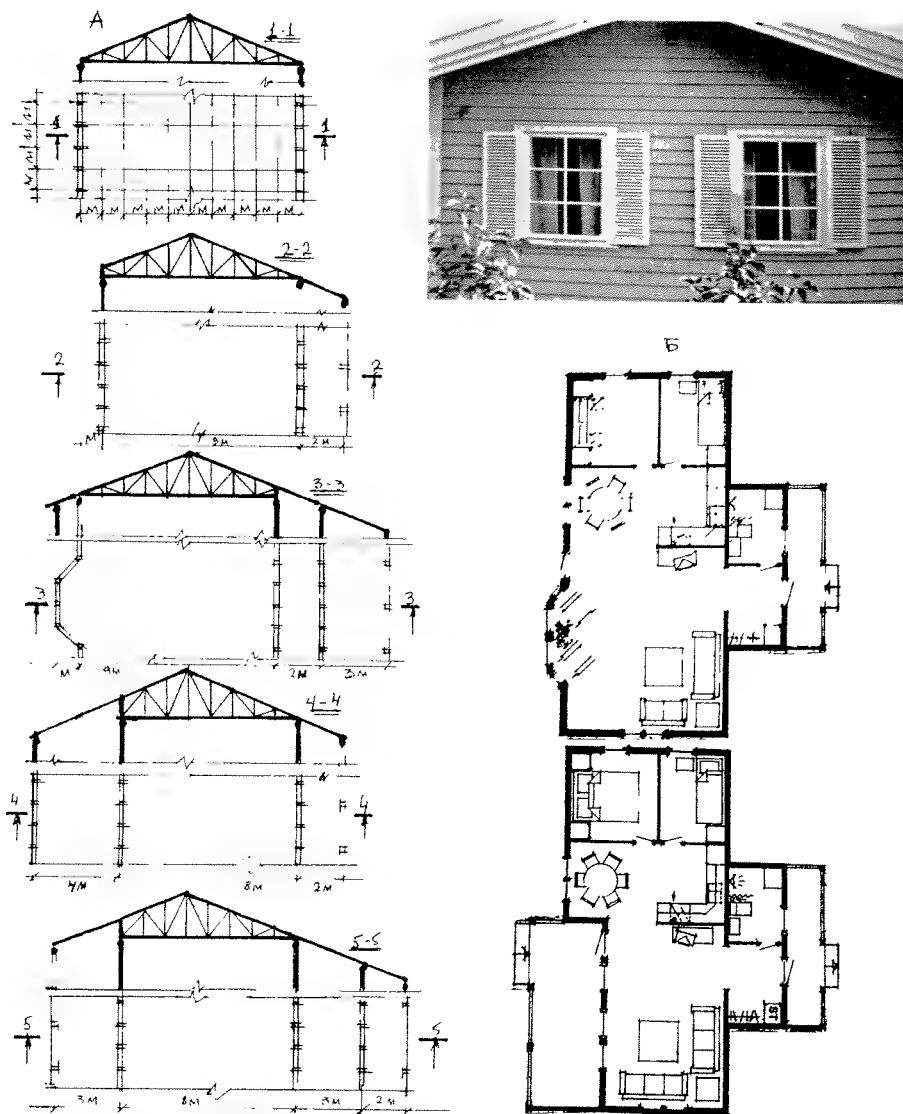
Одноэтажные каркасные здания с применением треугольных ферм: А — варианты объемно-планировочных приемов; Б — примеры планировок
